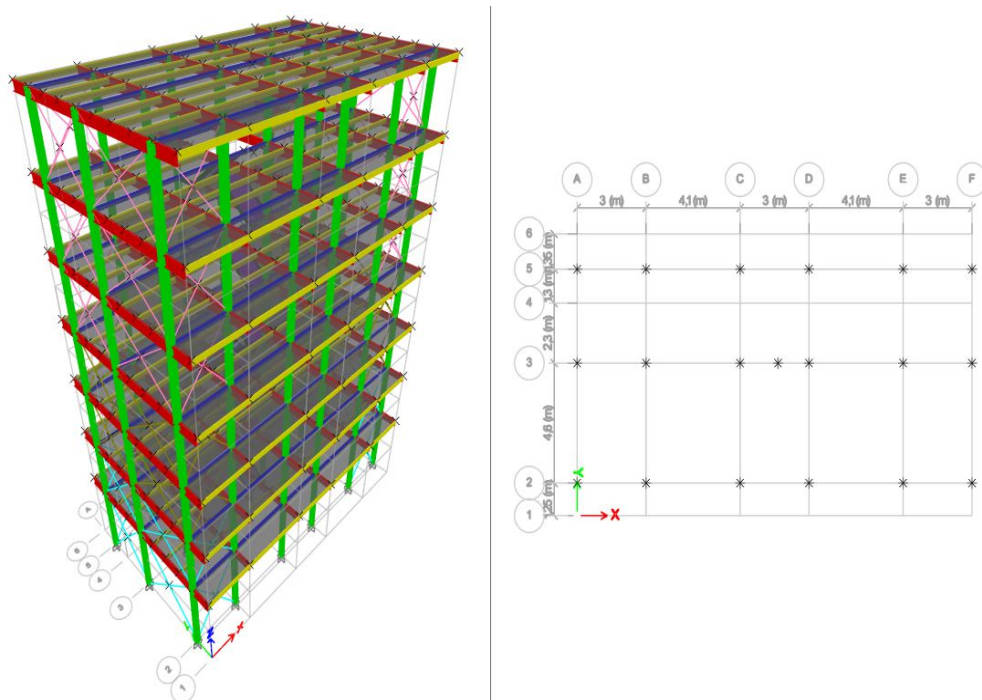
Vue 3D et en plan de la structure avec des poteaux mixtes HEB280.
